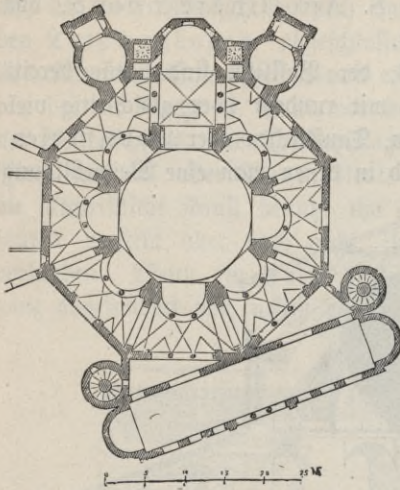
Ravenna. Grundriß der Kirche S. Vitale.
